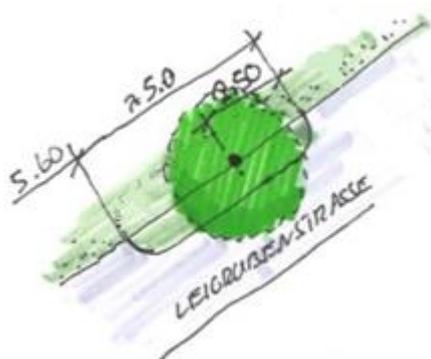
Einengung mit Baum (Strassenbreite von 4 m)
